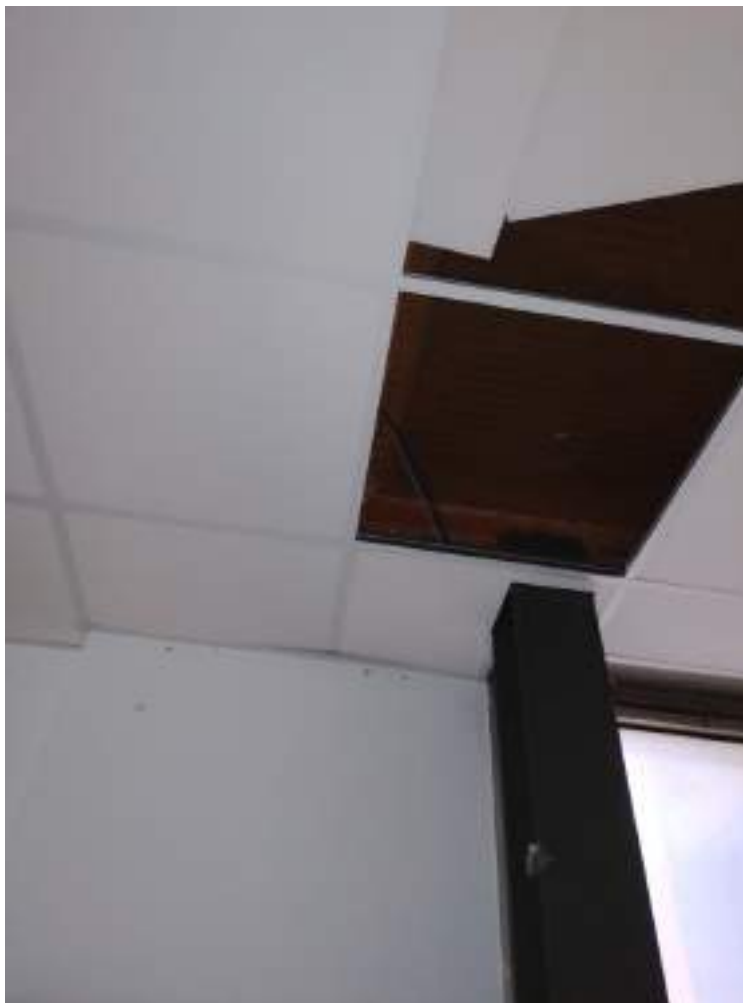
Particolare del saggio interno a soffitto piano primo nella zona dove sarà inserita nuova piattaforma elevatrice per verifica orientamento travetti solaio
